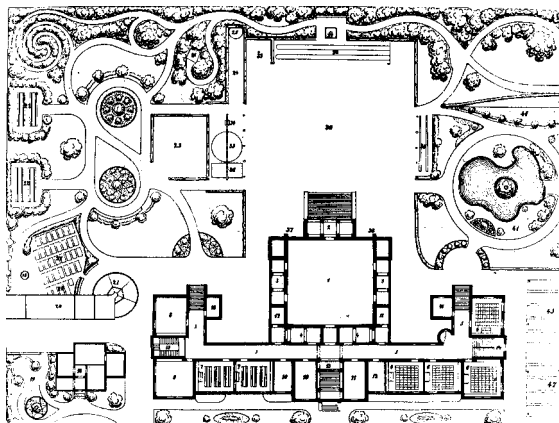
Erdgeschoßplan des „Volksschulhauses“ mit Gartenanlagen nach Georgens ²
